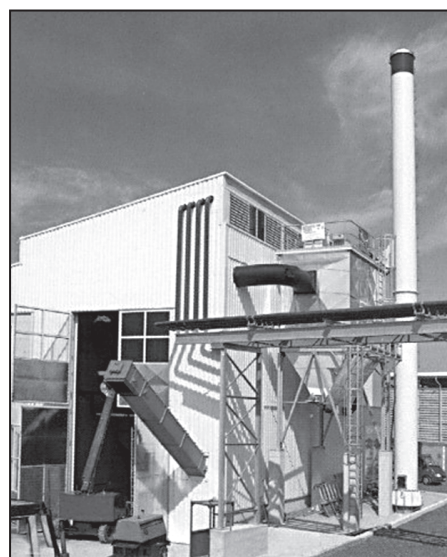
Установка на биомассе после окончания строительно-монтажных работ.
